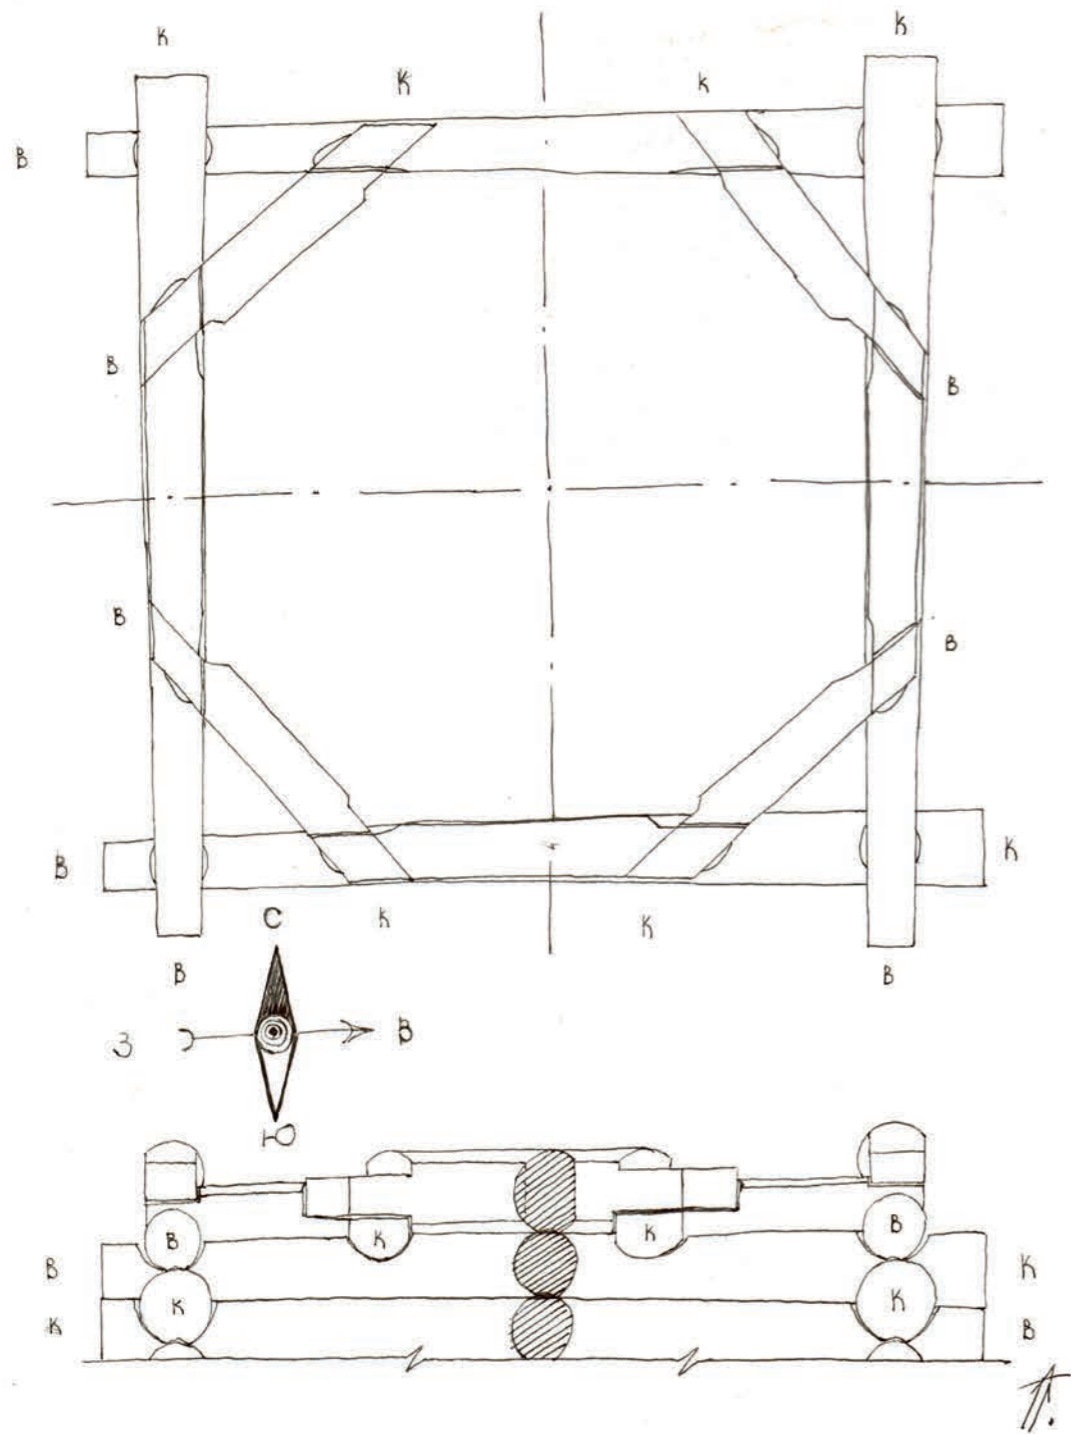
Окладные венцы малого восьмерика, срубленные на стоечно-балочной конструкции. План и фасад
